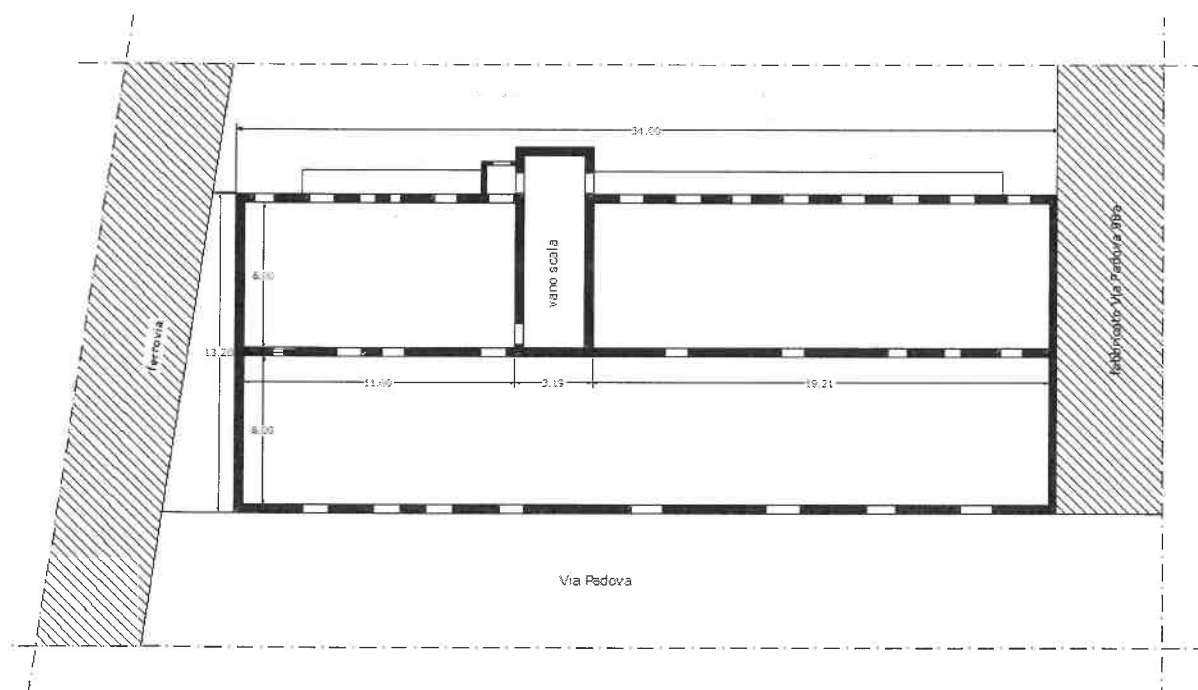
schema struttura portante dell'unità strutturale in oggetto
